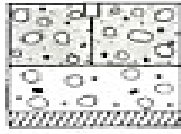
Structure d'une chaussée souple. (Michai (2006)).
